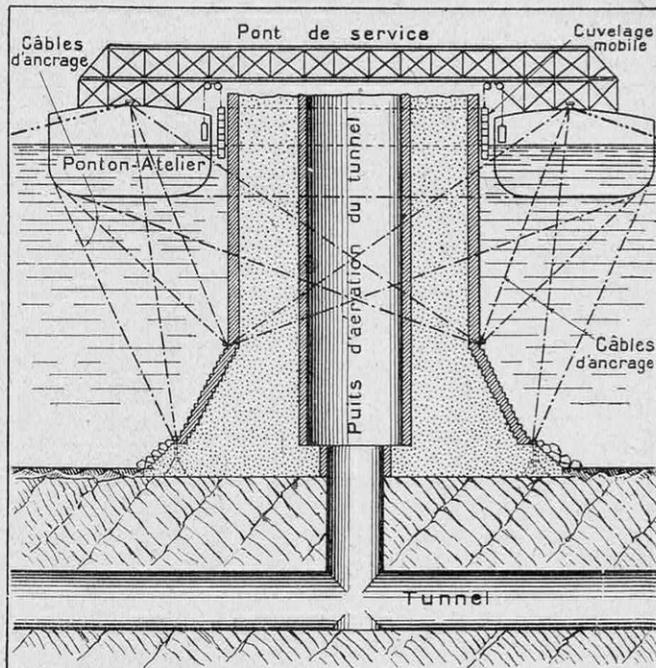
COUPE SUIVANT L'AXE D'UNE PILE ET D'UN TUNNEL MONTRANT LE CHANTIER DE RÉALISATION. ÉCHELLE : 1/400^e
